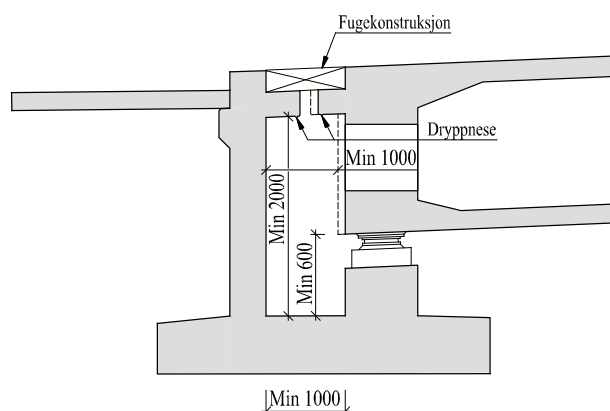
Krav til frihøyde ved lagre – 2 sidig tilk/fast ell. bev. lager
